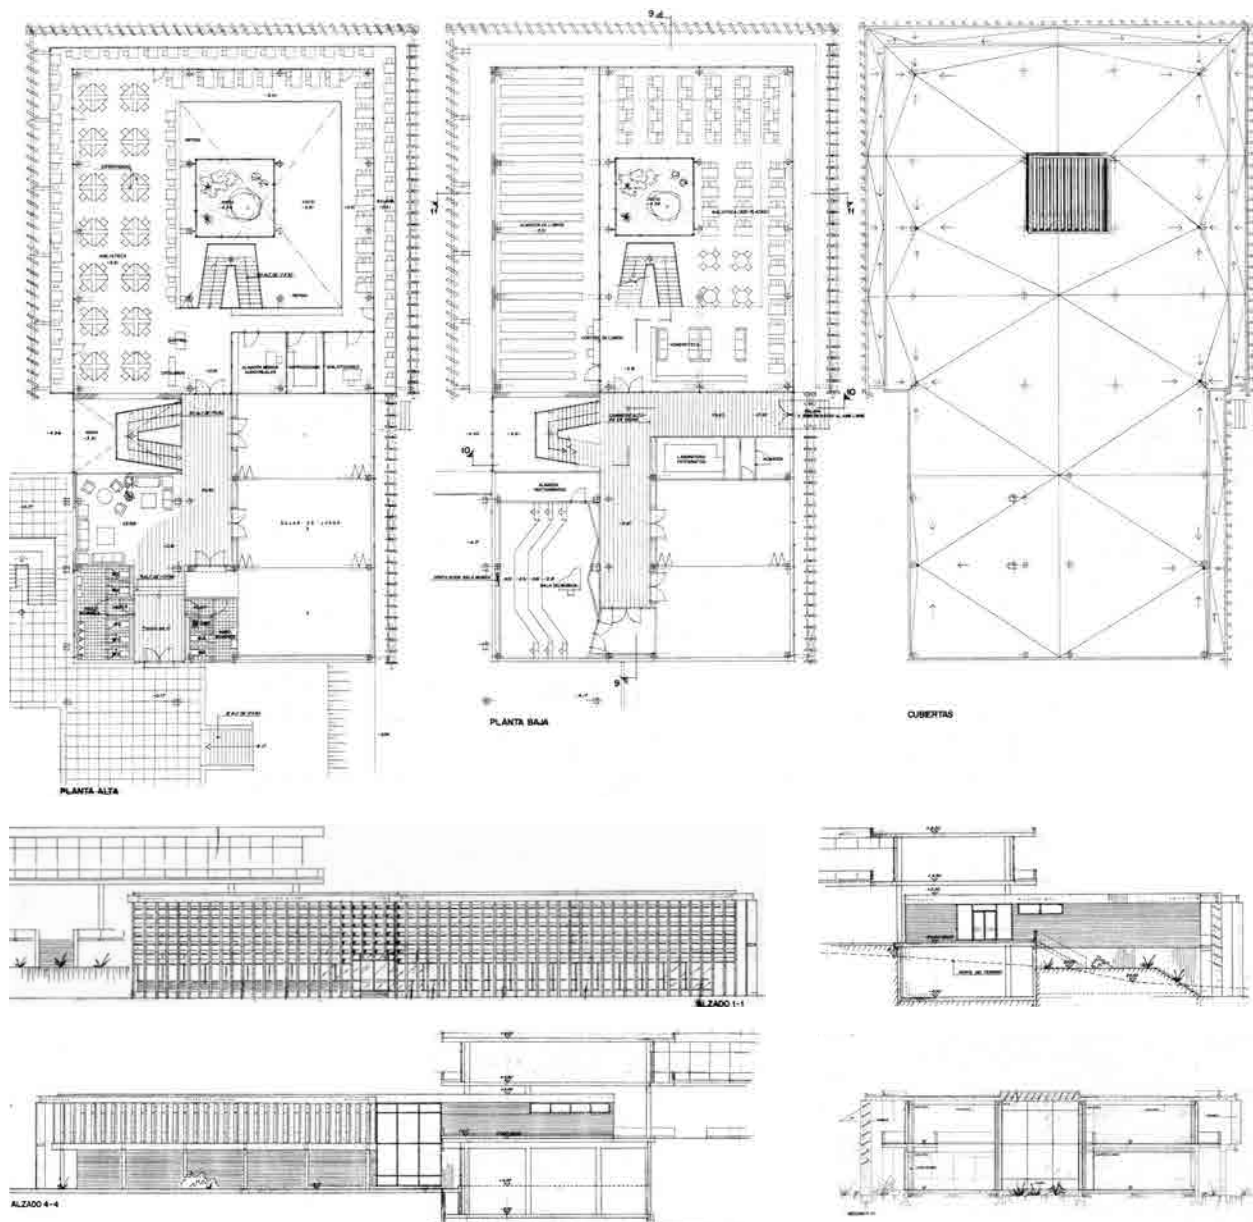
, Fig. 67, Fig. 68, Fig. 69, Fig. 70, Fig. 71 y Fig. 72 Edificio del club-biblioteca. Planta superior (arriba izquierda), planta inferior (arriba centro), planta de cubiertas (arriba derecha), alzado de la fachada Sur (centro izquierda), alzado de la fachada Oeste (centro derecha), alzado de la fachada Norte (abajo izquierda) y sección transversal por el patio (abajo derecha).
